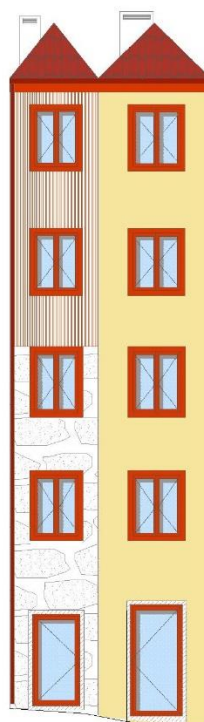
Fachada Tardoz (Fonte: Porto Vivo, SRU)
